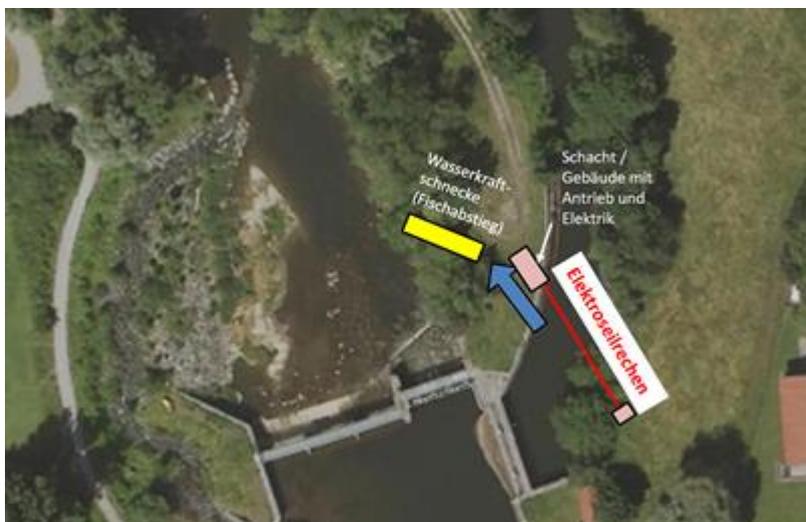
Lageplan der Ausleitungssituation mit dem neu zu errichtenden Elektro-Seilrechen
